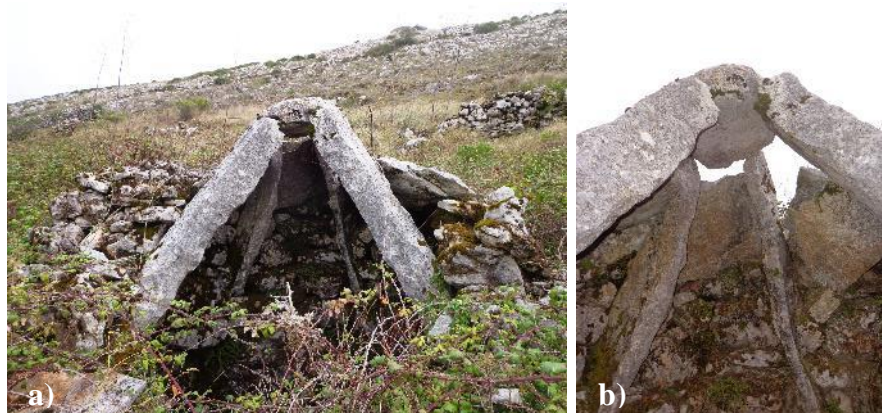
Poço coberto: a) Vista geral; b) Ligação das vigas da cúpula cónica com a chave de remate
